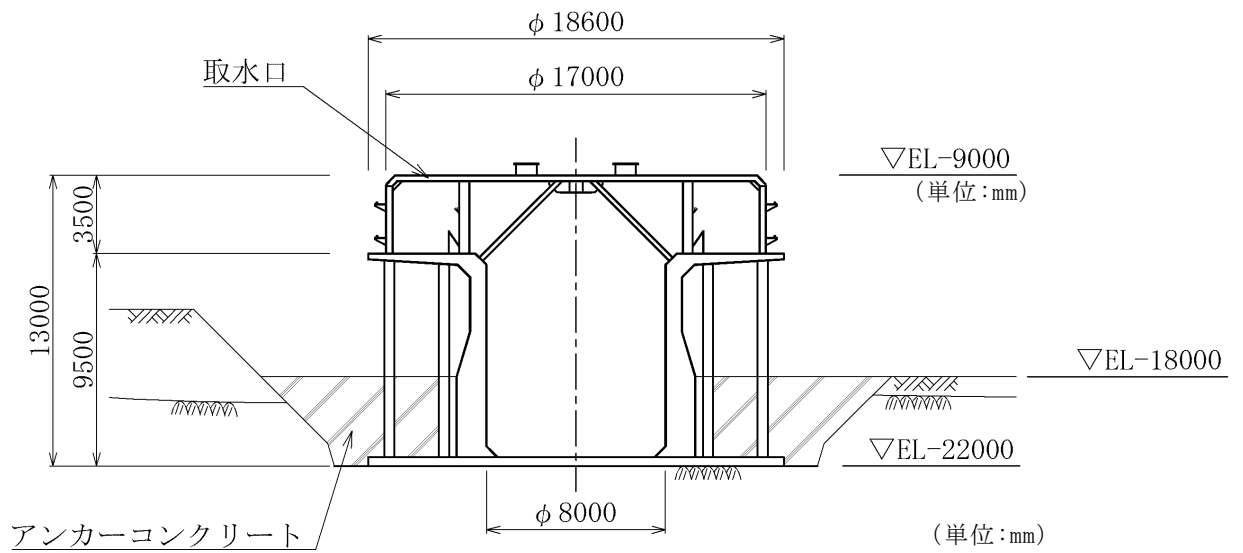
(2) 取水口 断面図 (B-B 断面)
